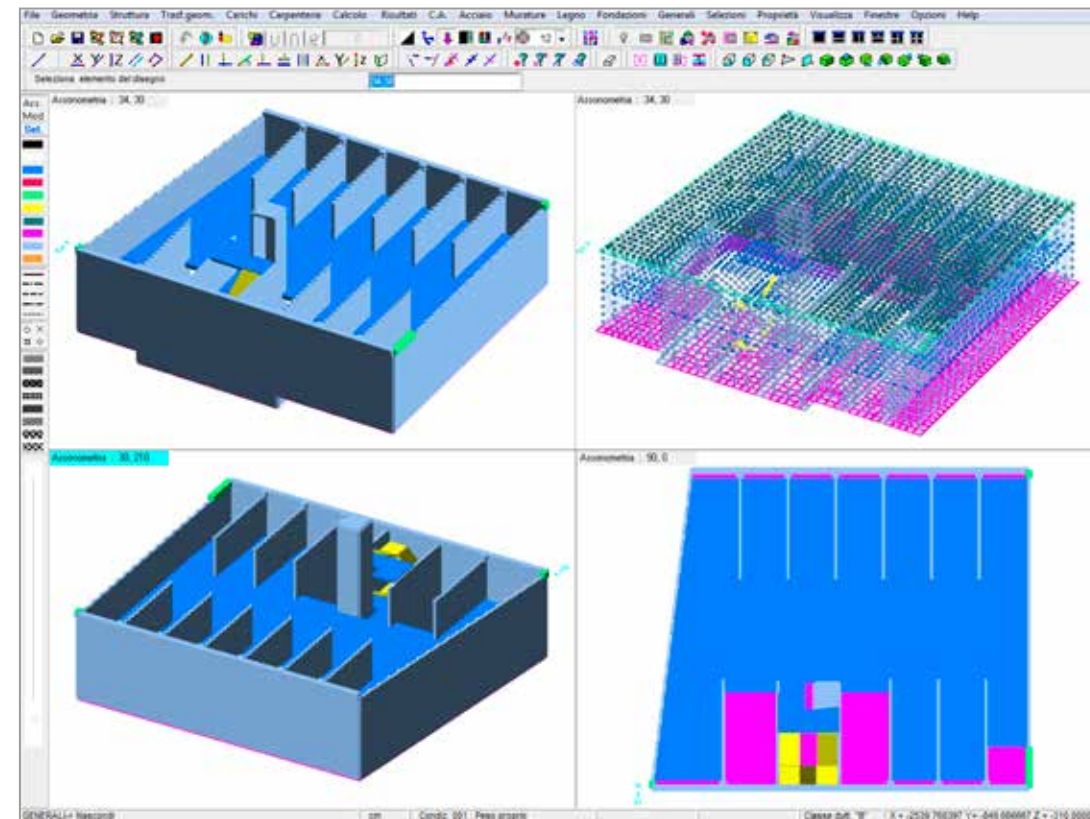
Il modello tridimensionale nel CAD 3D Struttura
